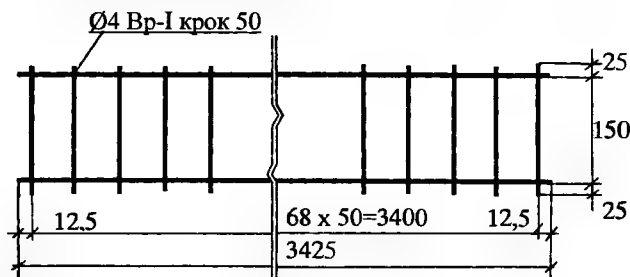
Креслення плоского арматурного каркаса КР-19 після замінення арматури
